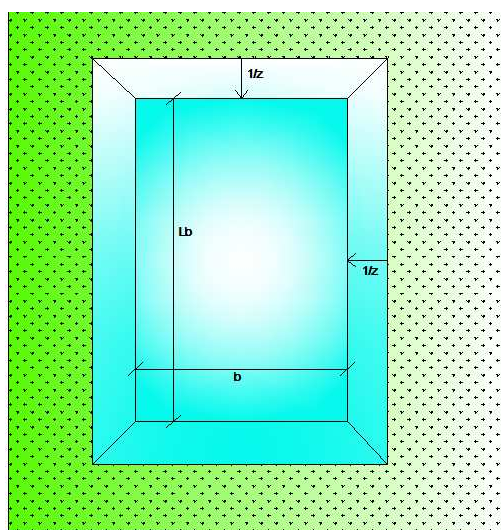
Planta da bacia de retenção com geometria prismática.
